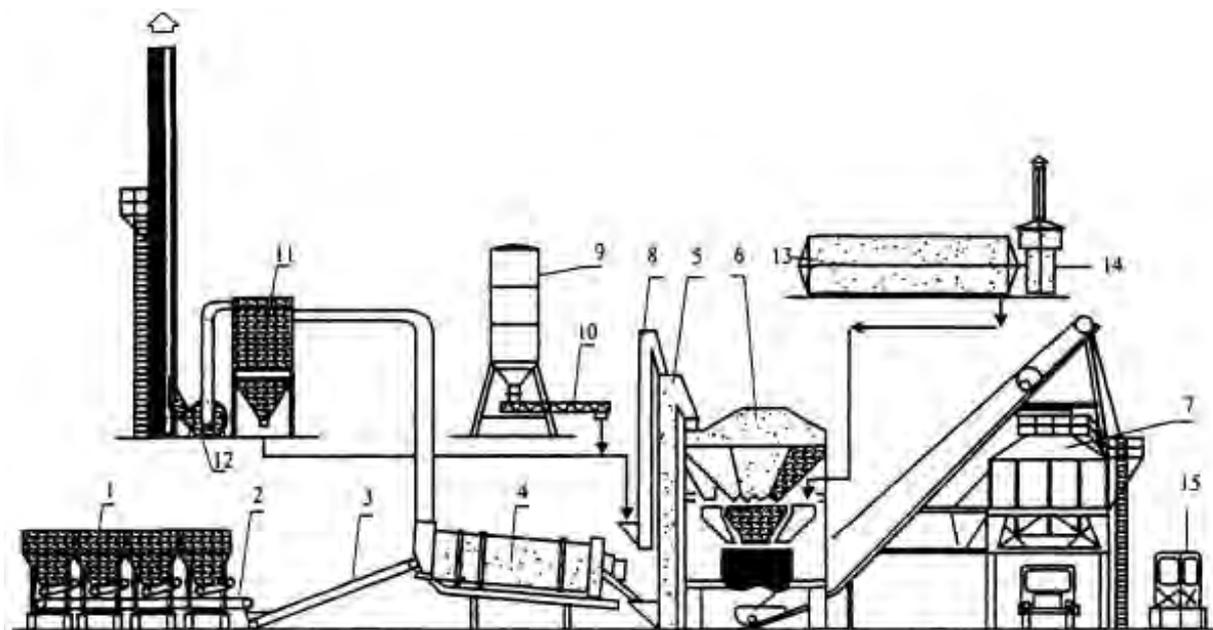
Технологическая схема асфальтосмесительной установки ОАО «Саста»: 1 — агрегат питания; 2 — сборный транспортер; 3 — наклонный транспортер; 4 — сушильный агрегат; 5 — «горячий» элеватор; 6 — горячие бункеры; 7 — бункер готовой смеси; 8 — элеватор минерального порошка и пыли; 9 — агрегат минерального порошка; 10 — шнек; 11 — рукавные матерчатые фильтры; 12 — вентилятор; 13 — расходная битумная емкость; 14 — нагреватель жидкого теплоносителя; 15 — кабина управления
